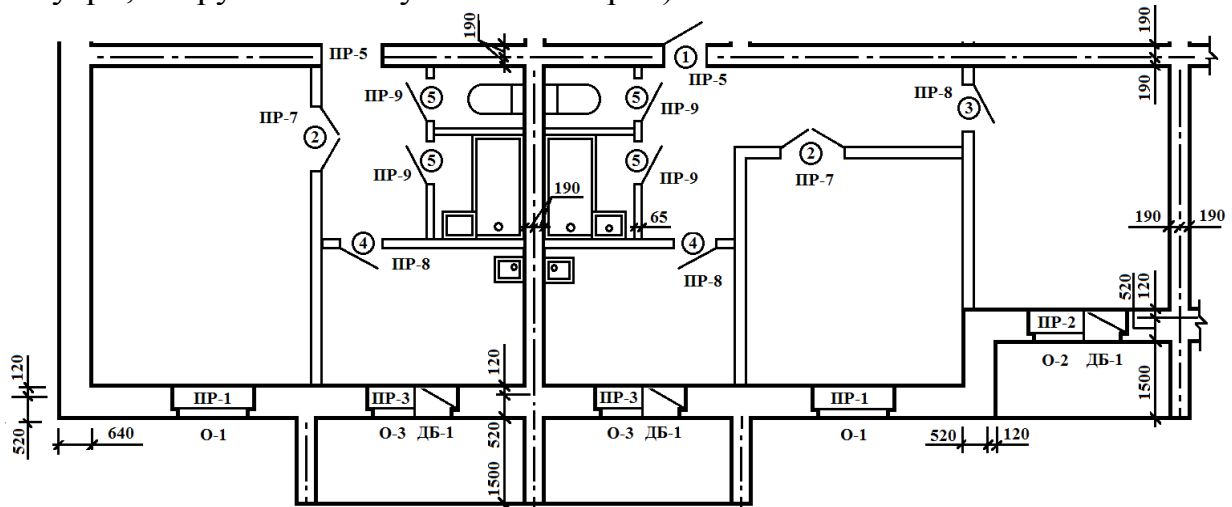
Фрагмент плана этажа с указанием марок проемов
